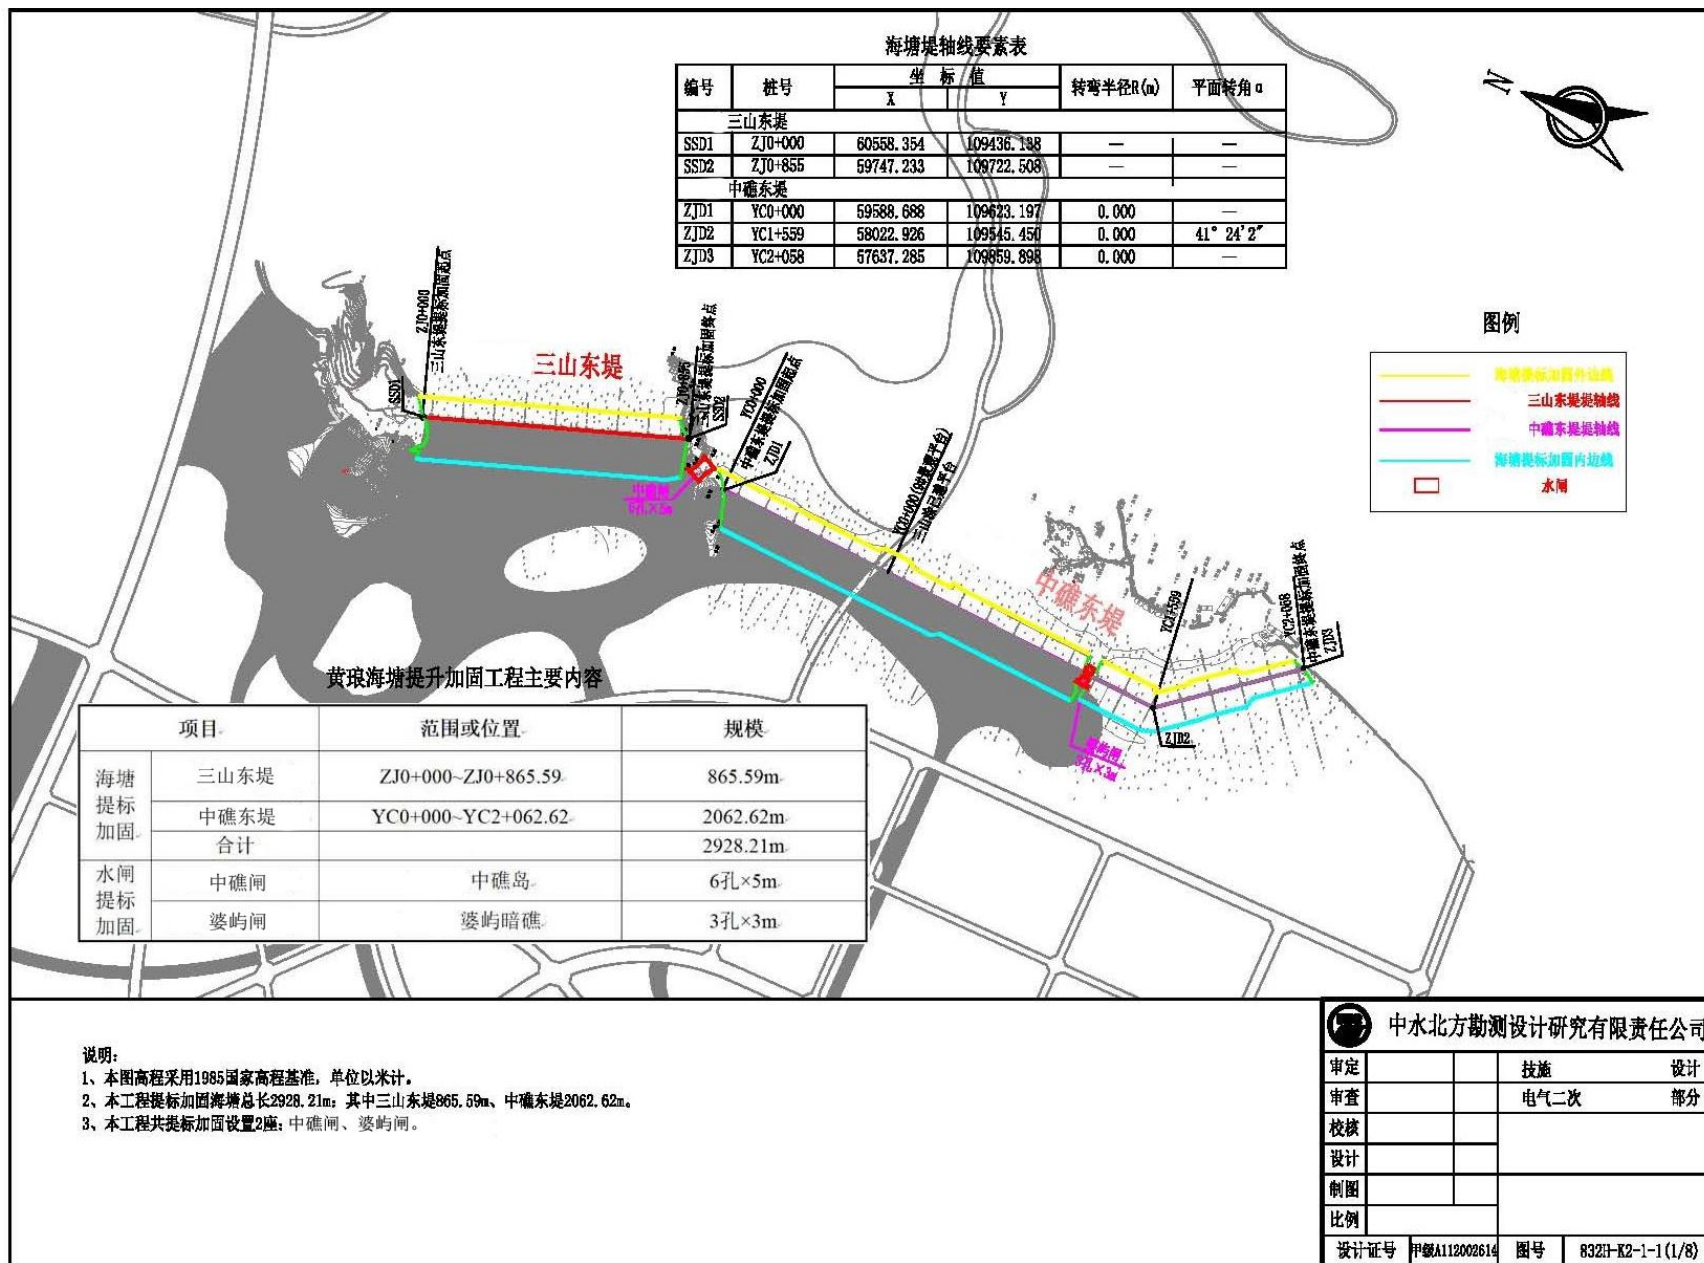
黄琅海塘提升加固工程总平面布置图
